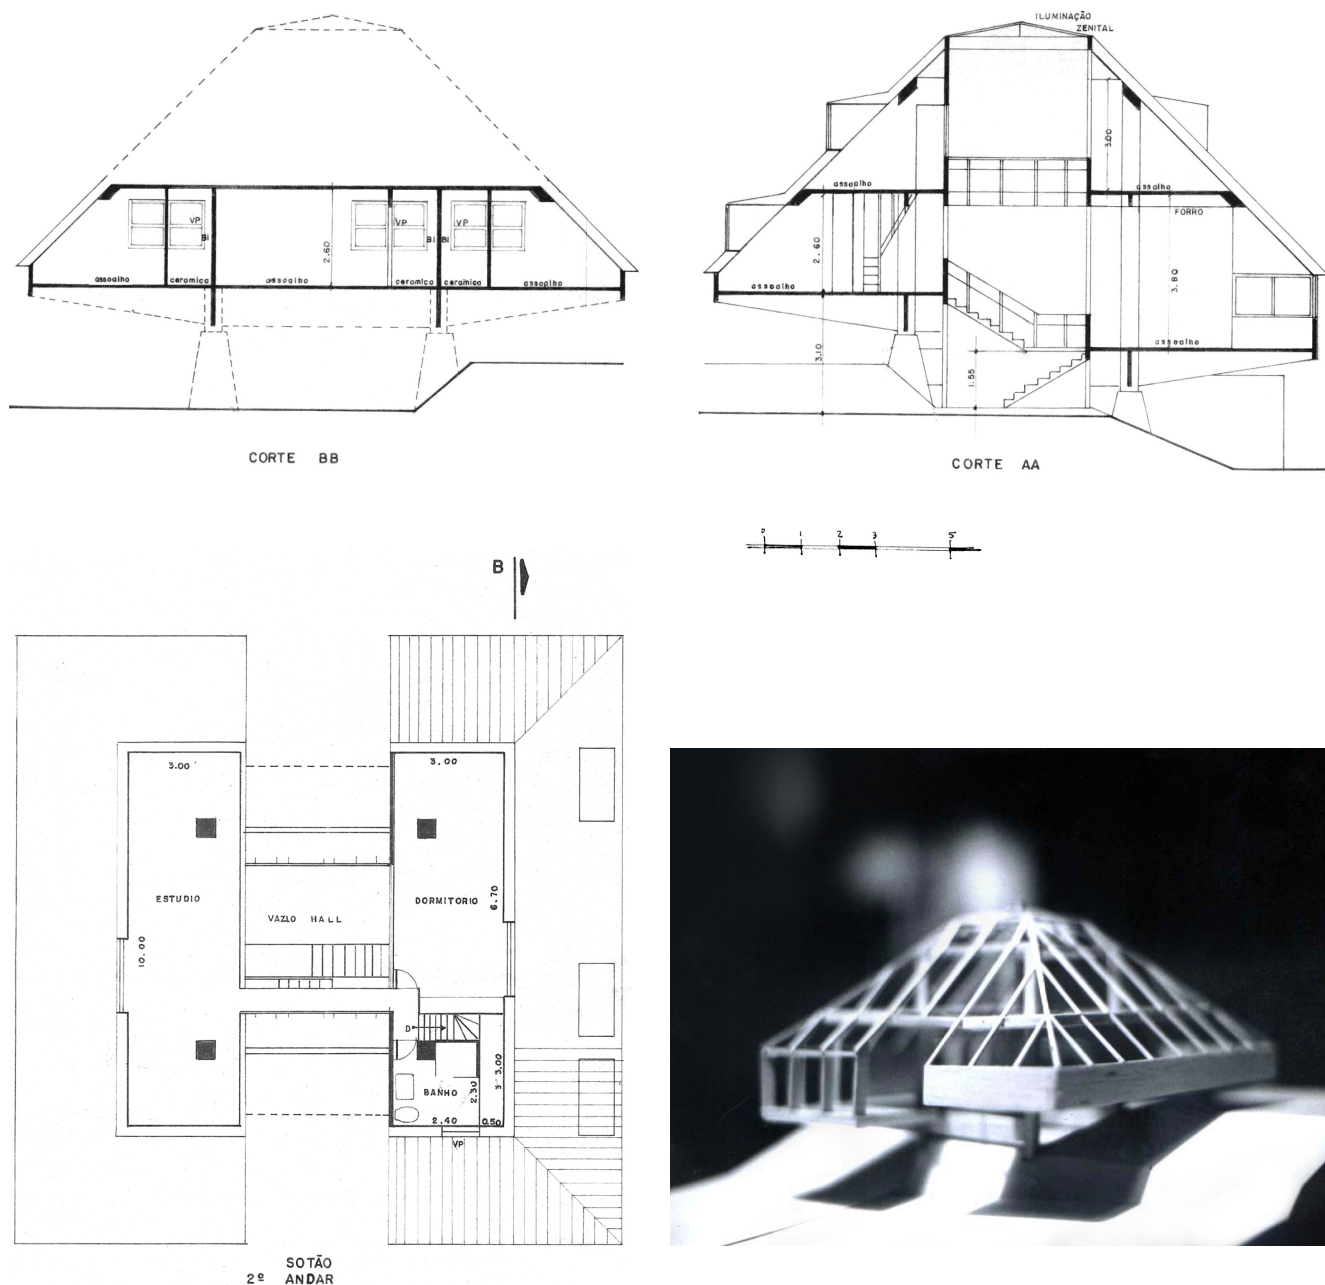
Desenhos dos cortes, planta baixa do pavimento superior e foto da maquete de estudo.
